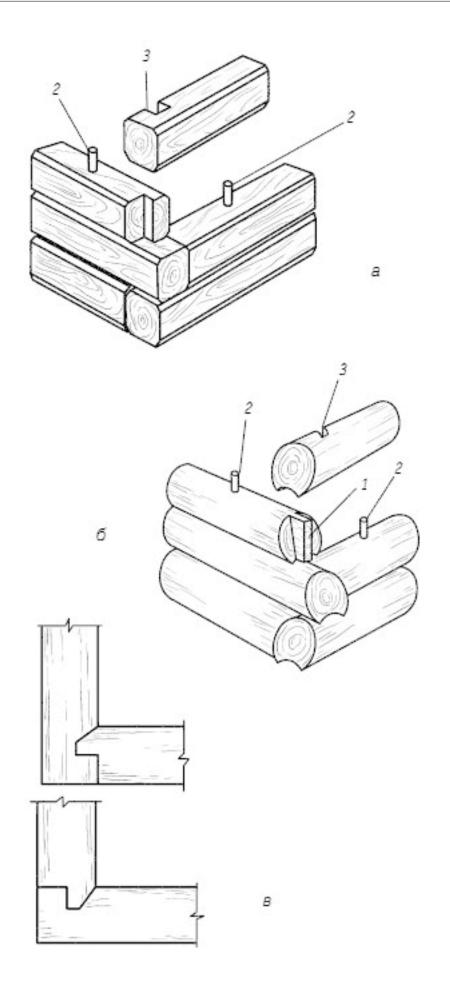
Угловые врубки упрощенной конструкции в торцевой шпунт: а — брусчатый сруб; б — бревенчатый сруб: 1 — шип; 2 — шкан; 3 — паз в — вид сверху на угловую
